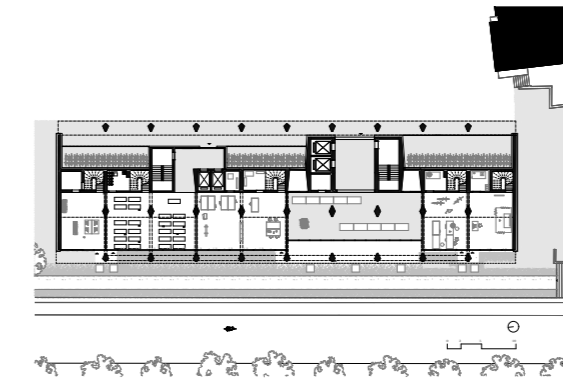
, 20: Grundrisse Erdgeschoss/Zwischengeschoss mit Wohnateliers
